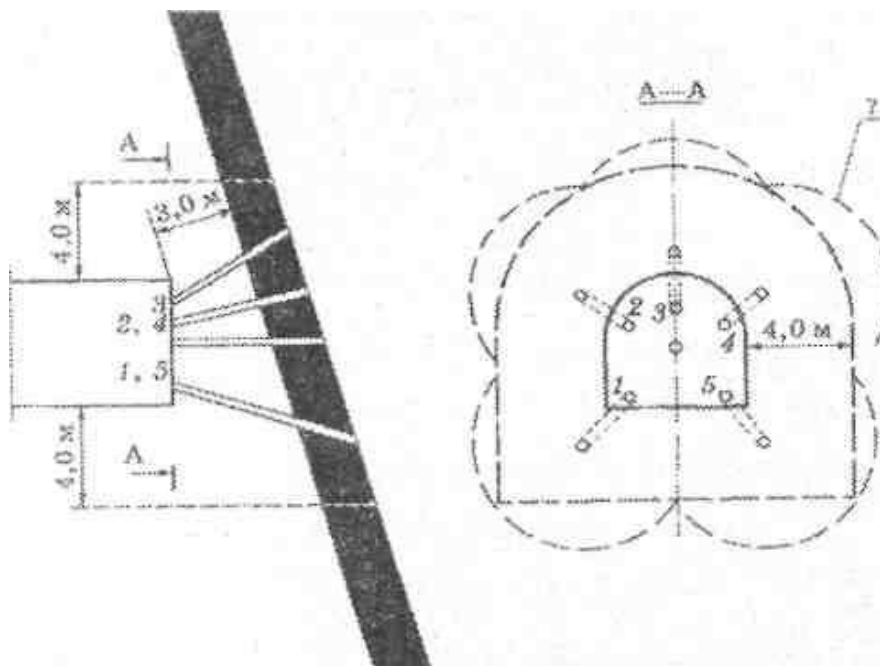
Схема расположения скважин для гидрорыхления перед вскрытием крутого и крутонаклонного угольных пластов:
